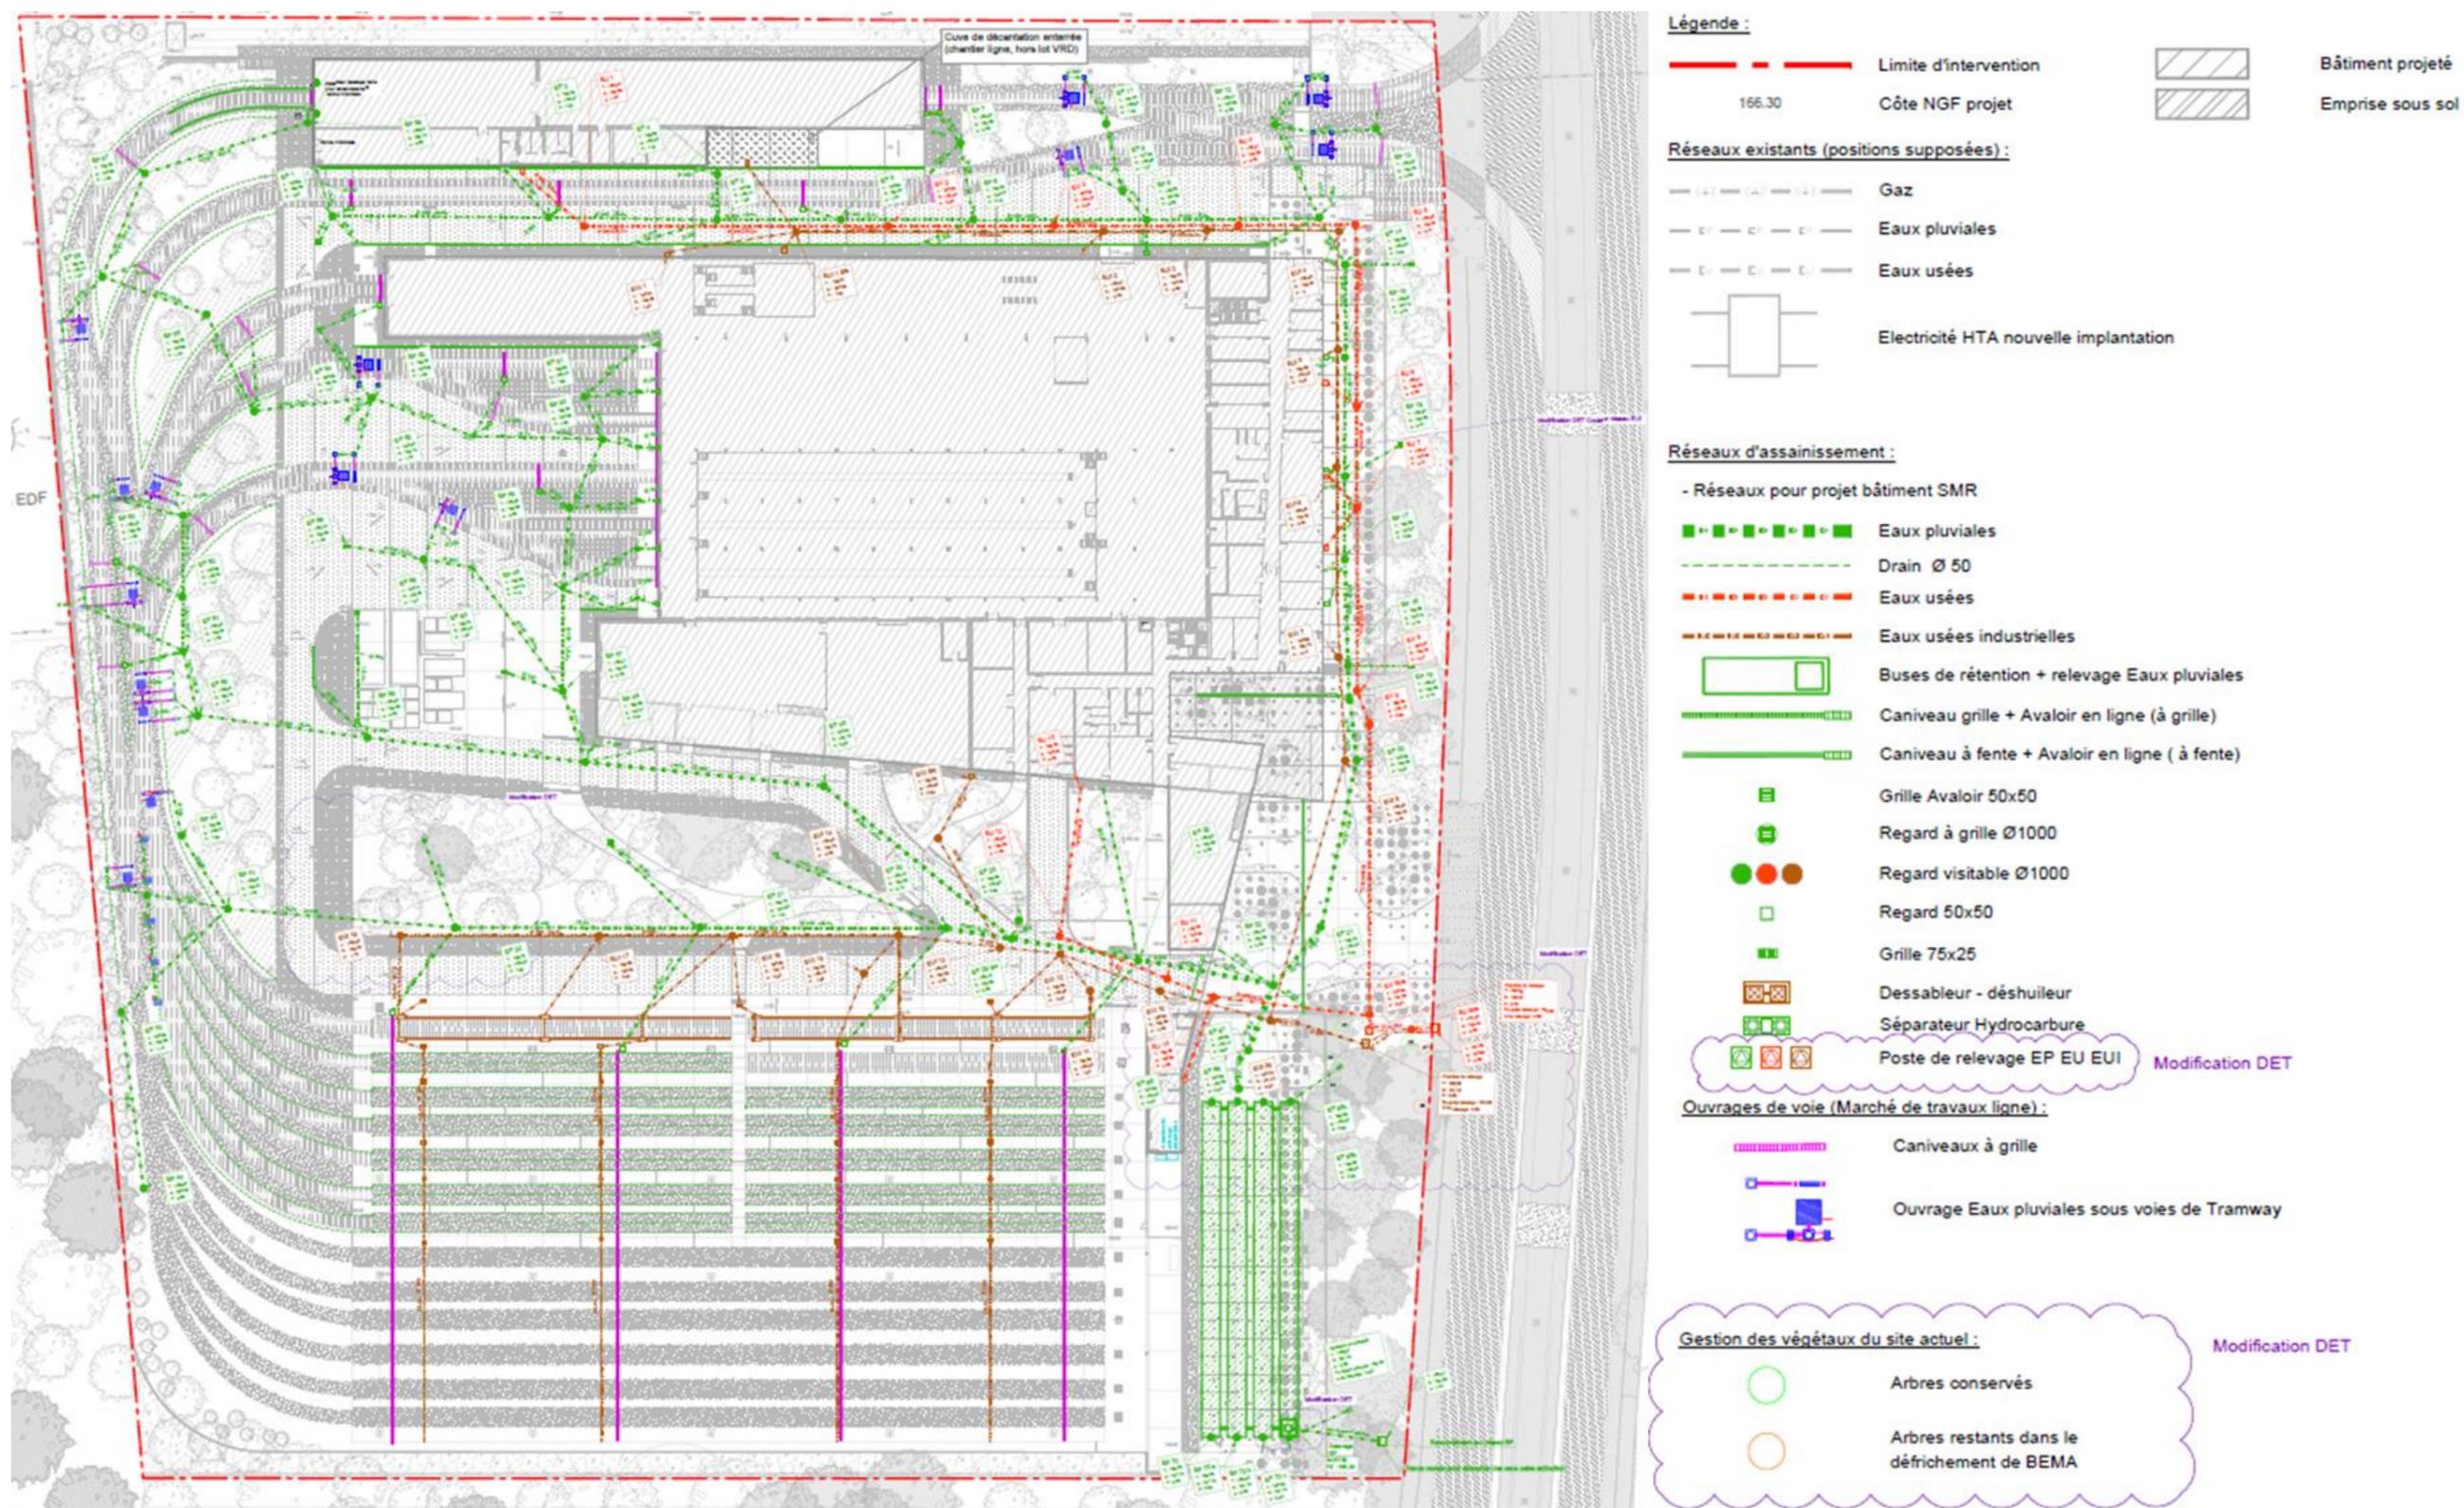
Plan général d'assainissement du site de maintenance et de remisage - Site sans dalle - Projet modifié, source : AIA
